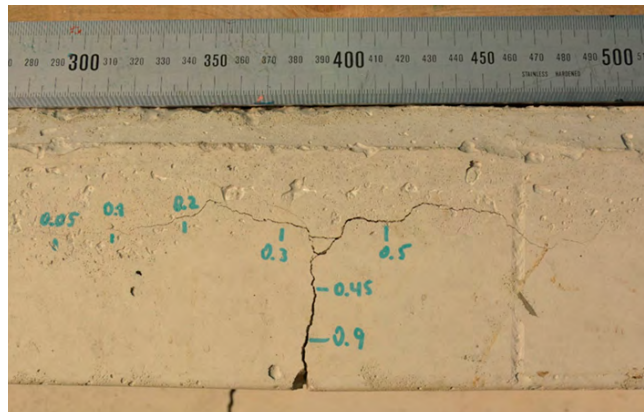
Foto del alma de una viga parcialmente pretensada, marcados encima de las fisuras su ancho en mm con el fisurómetro.
